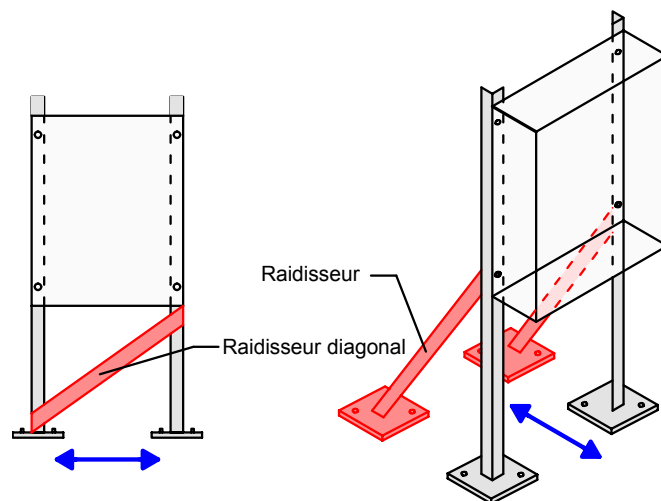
> Fixation d'armoires/boîtiers autonomes sur pieds
